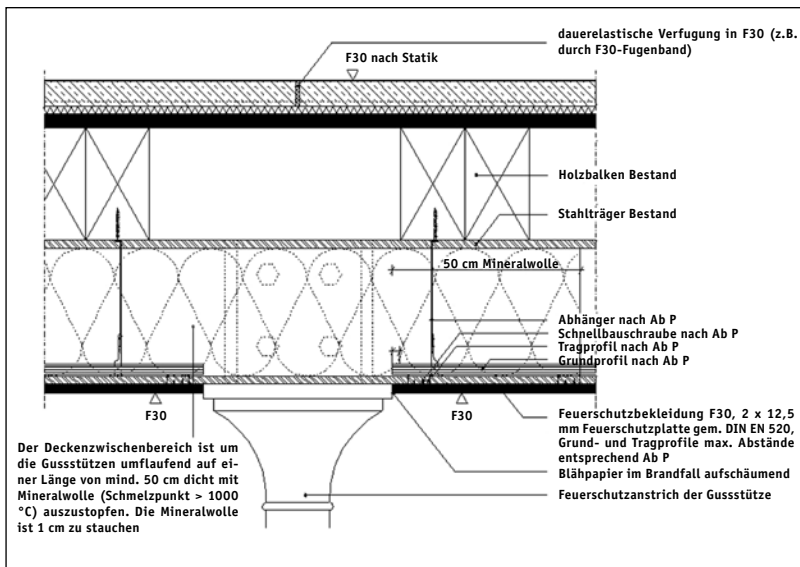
Blick auf die mit Trockenbau in F30 ertüchtigte Stahl-Guss-Konstruktion unter der Holzbalkendecke
